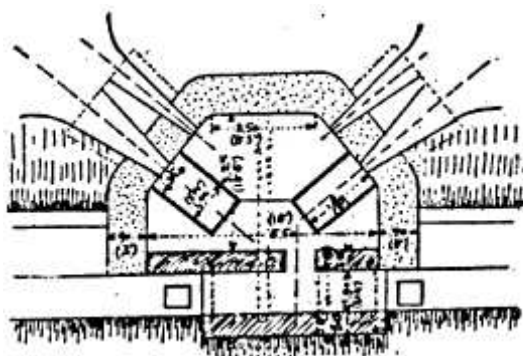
Půdorys pevnůstky se stropnicí z kolejnic a betonu
